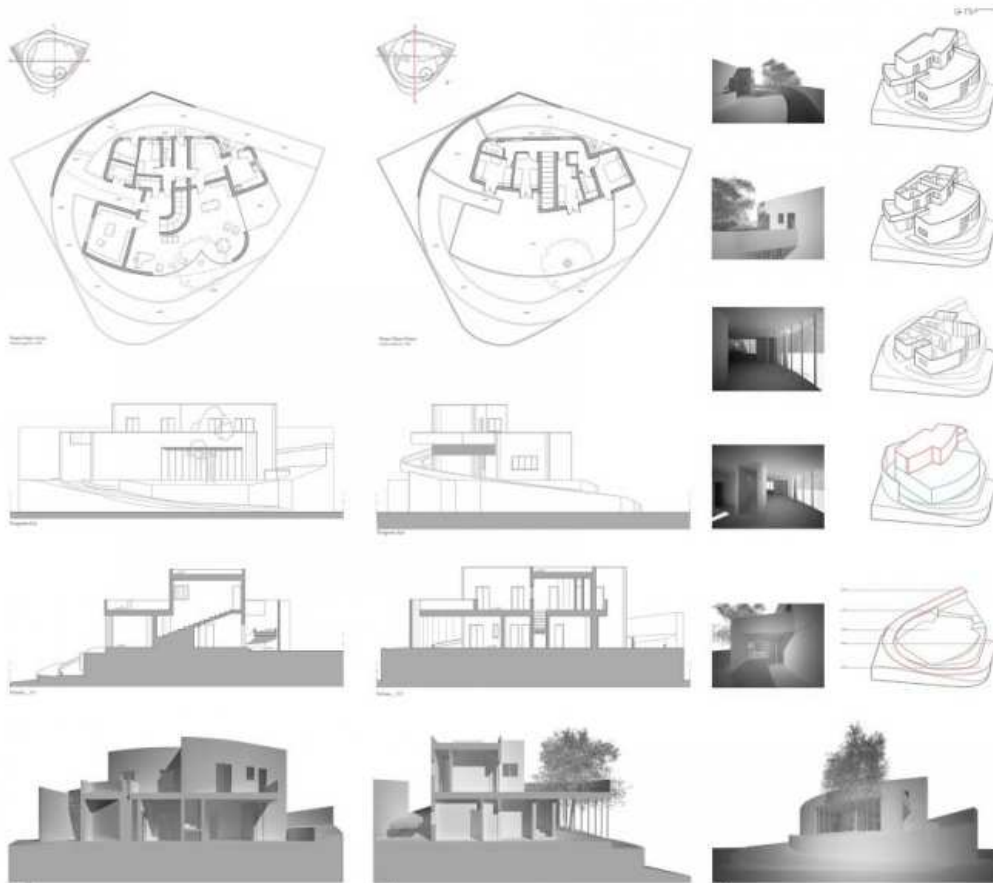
Casa do Chame-Chame*, schemi, ridisegno delle piante, dei prospetti, delle sezioni, viste prospettiche, sezioni prospettiche e schemi assometrici della quarta versione (elaborazione grafica di M. G. Carollo).
